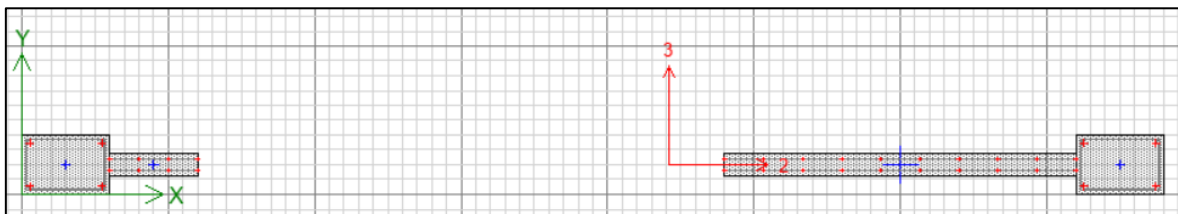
Armado de enchape, muro con ventana, Vivienda B.
